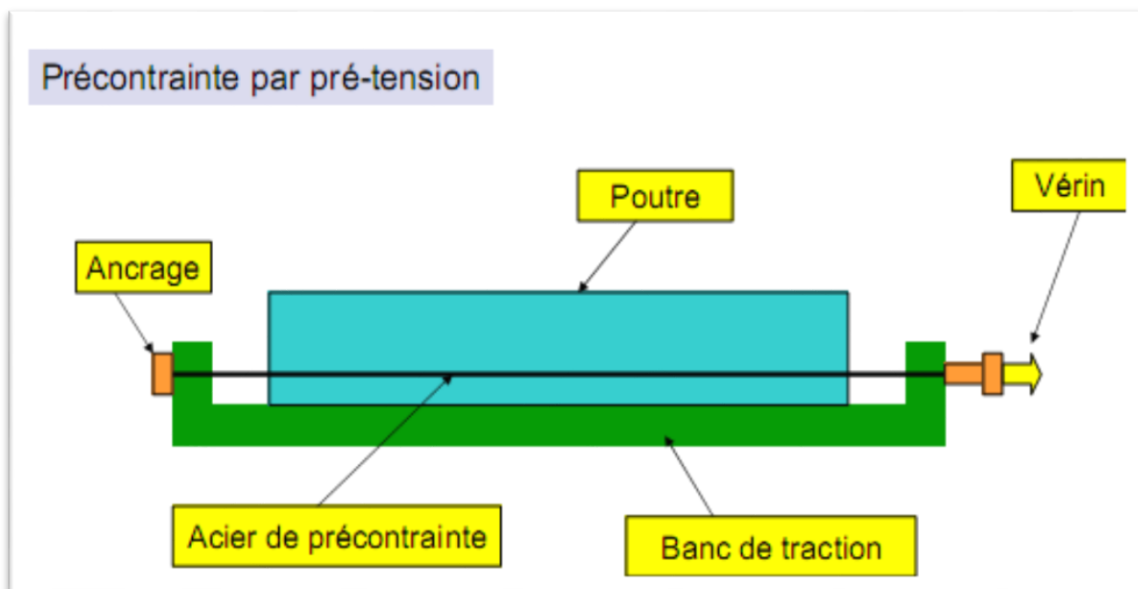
Coupe longitudinale d'une poutre en béton précontraint pré tension
